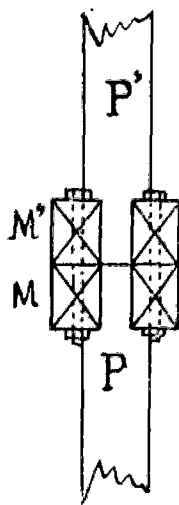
Autre disposition d'assemblage des poteaux d'une palée.
